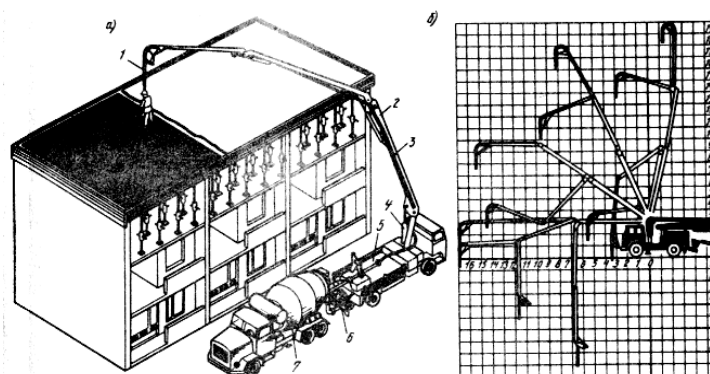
Подача раствора бетона автобетононасосом:
